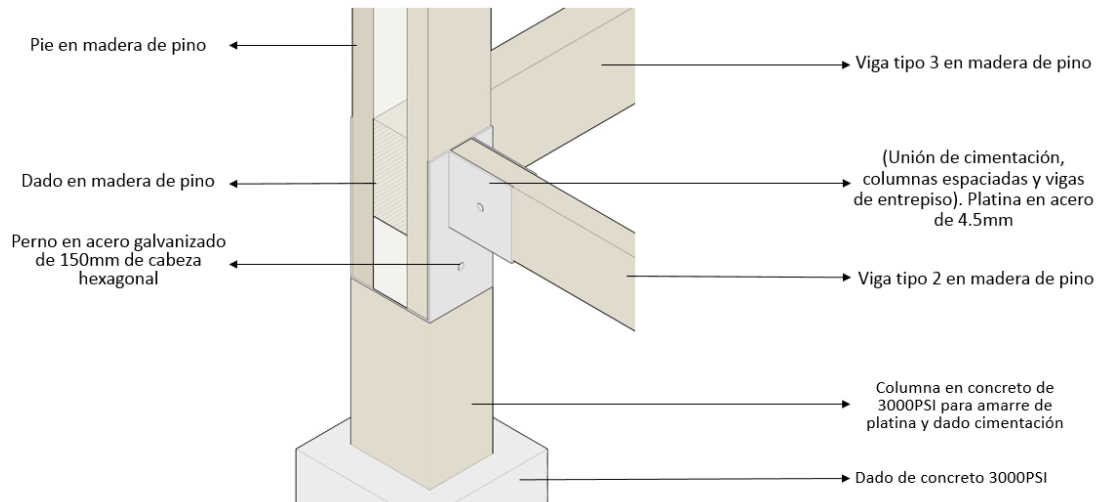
Unión de platina con vigas de entrepiso y columna espaciada
